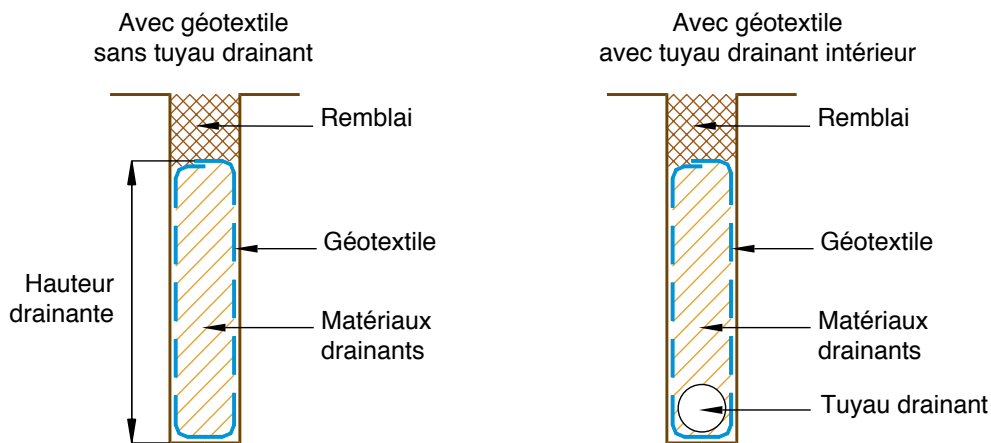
Coupe type d'une tranchée drainante peu profonde - coupes types selon le Guide drainage routier (Sétra, 2006)
